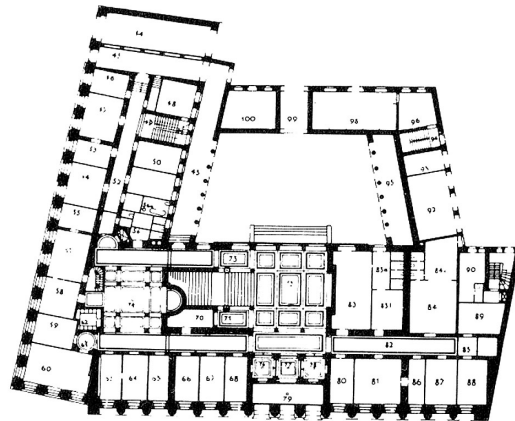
P. Behrens, *Dt. Botschaft St. Petersburg*, Grundriss EG
